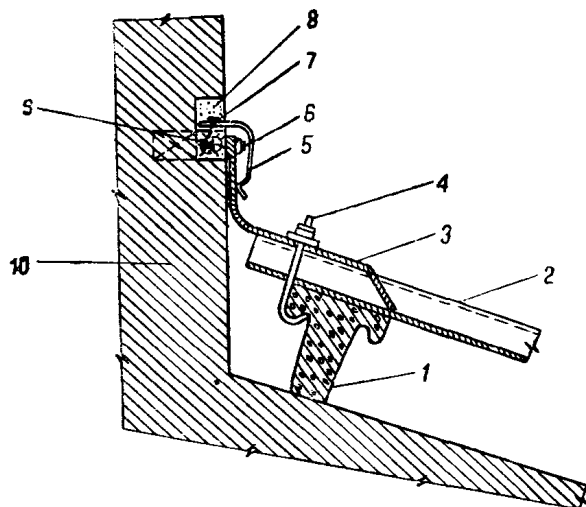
Примыкание кровли из асбестоцементных волнистых листов к стене
